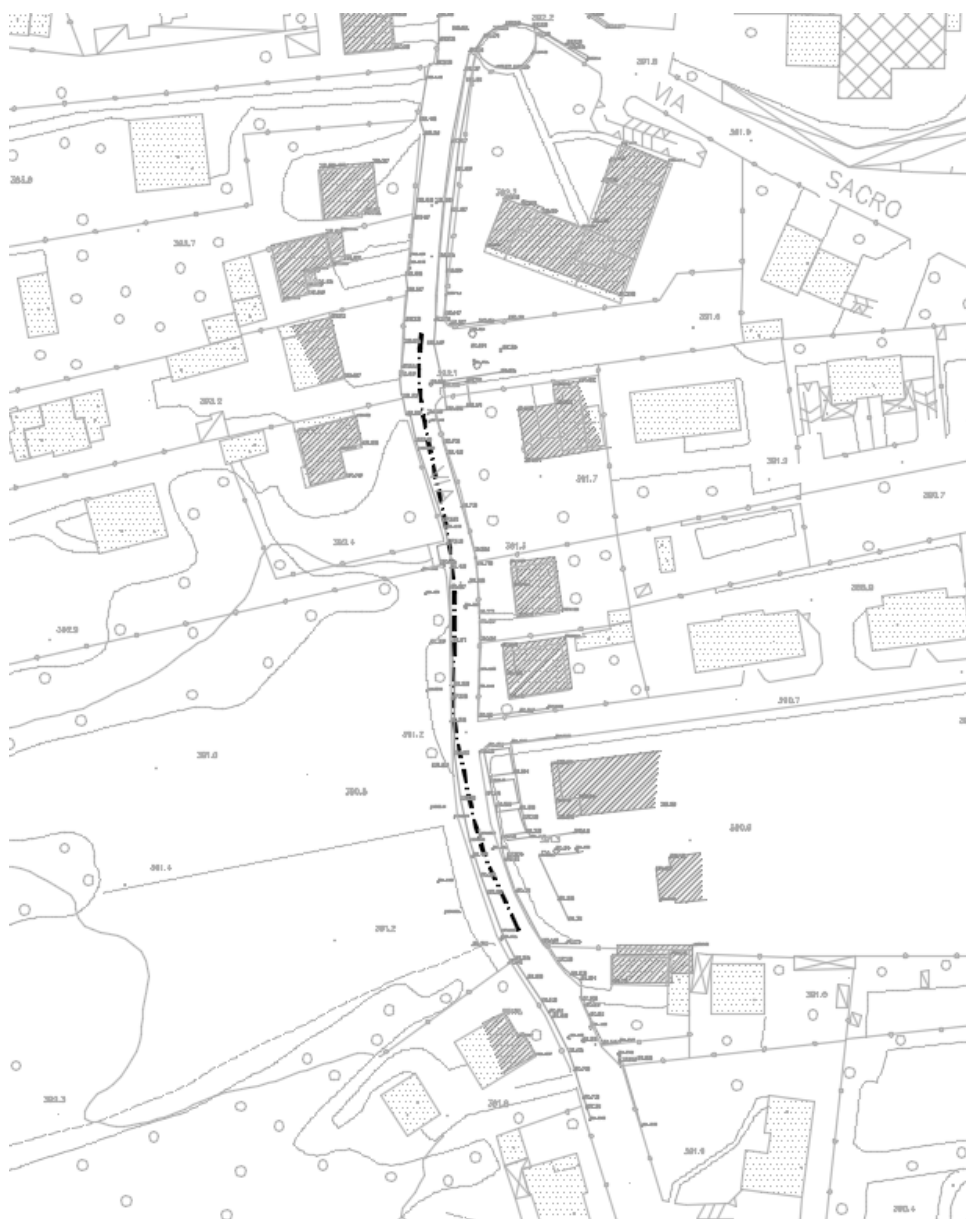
Nuovo asse viario rispetto agli estremi della sede attuale
